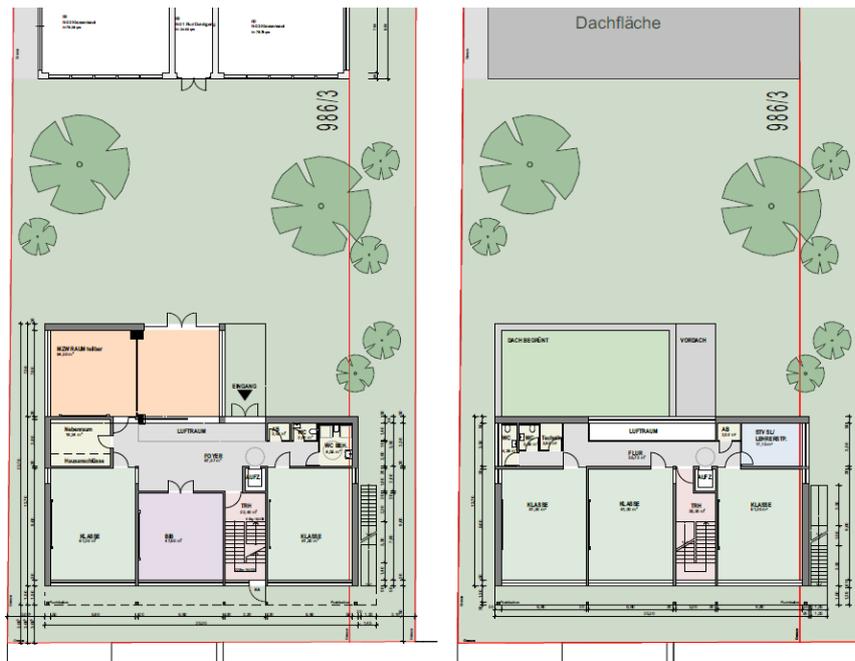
Lage des Neubaus im südlichen Bereich der Fläche mit Raumaufteilung; Erdgeschoß (links), Obergeschoß (rechts); Entwurf Juli 2020
